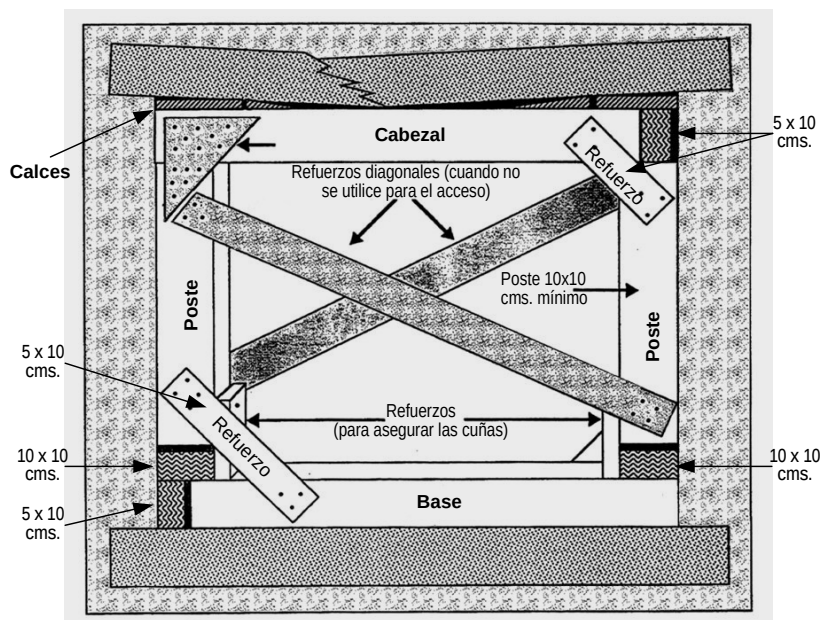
Detalles de construcción de apuntalamiento ventana/puerta (sin acceso).
